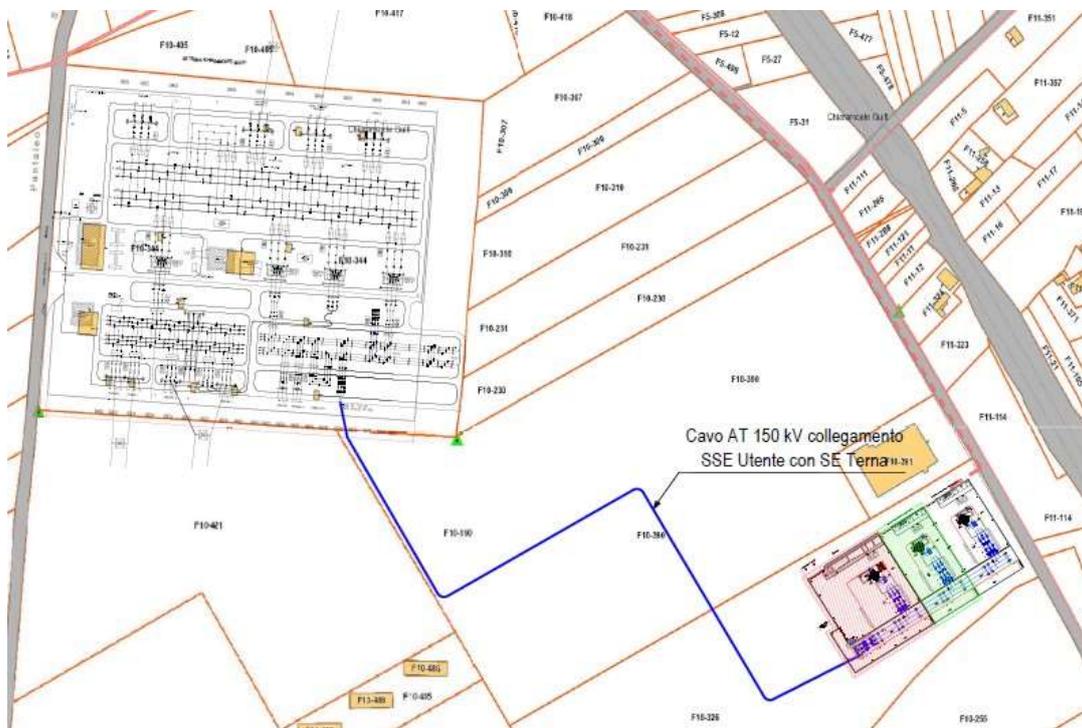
Planimetria generale SSE Chiamonte Gulfi (RG) e Stallo condiviso
